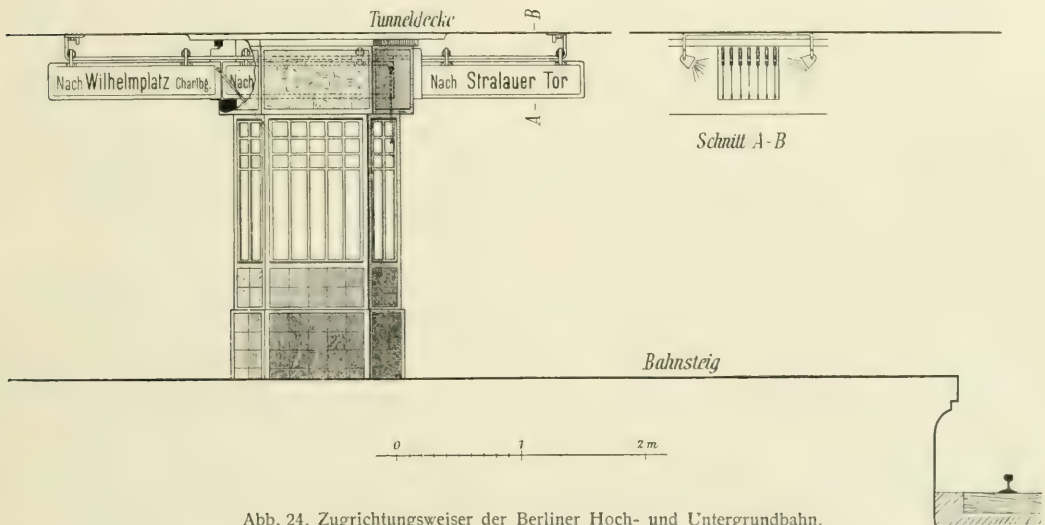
Zugrichtungsweiser der Berliner Hoch- und Untergrundbahn.
